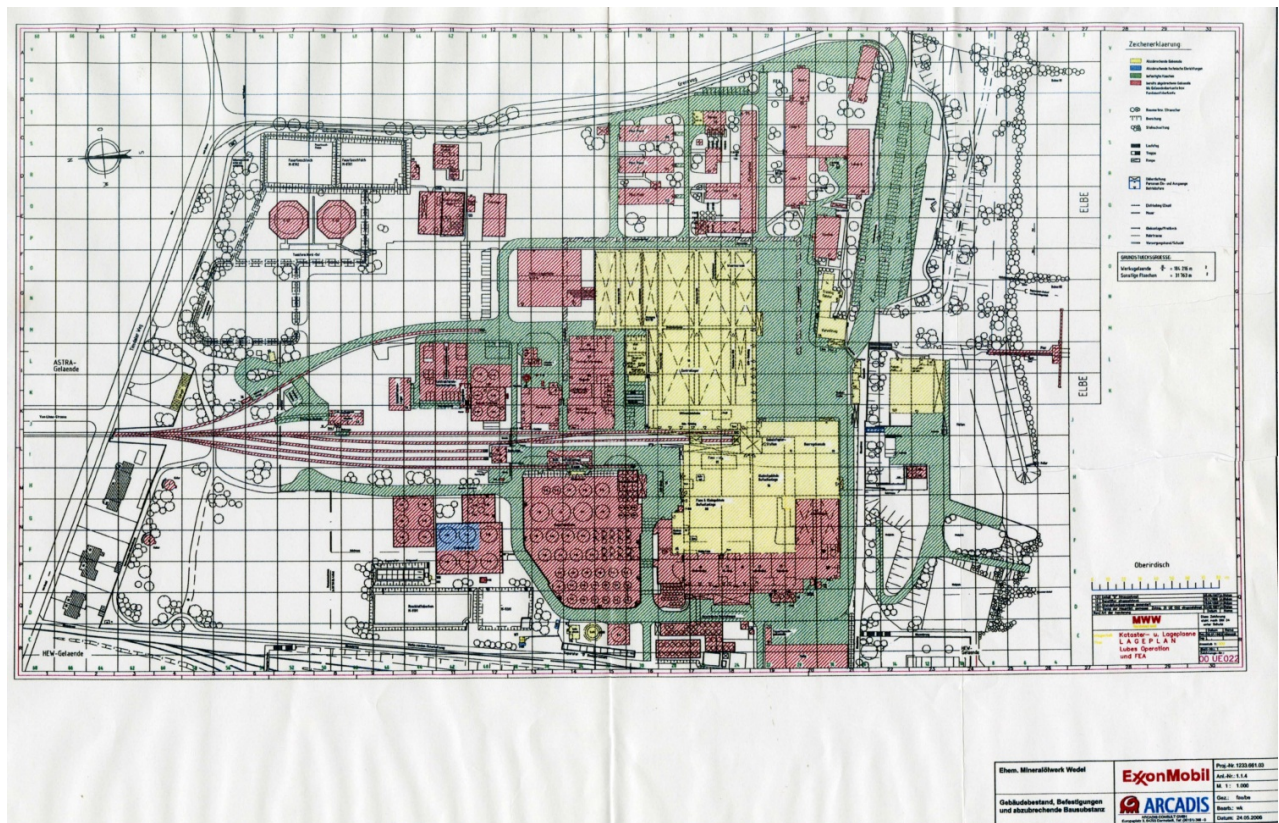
Bestandsermittlung versiegelter Flächen vor der Sanierung; Kataster und Lageplan: Gebäudebestand, Befestigungen und abzubrechende Gebäude ARCADIS 2006
